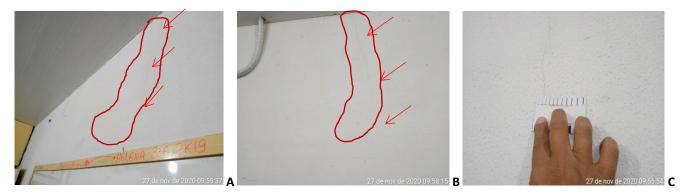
A) Fissura transpassante na sala 3. B) Mesma fissura da foto "A" só que na sala 4. C) Abertura de 0,2mm.
